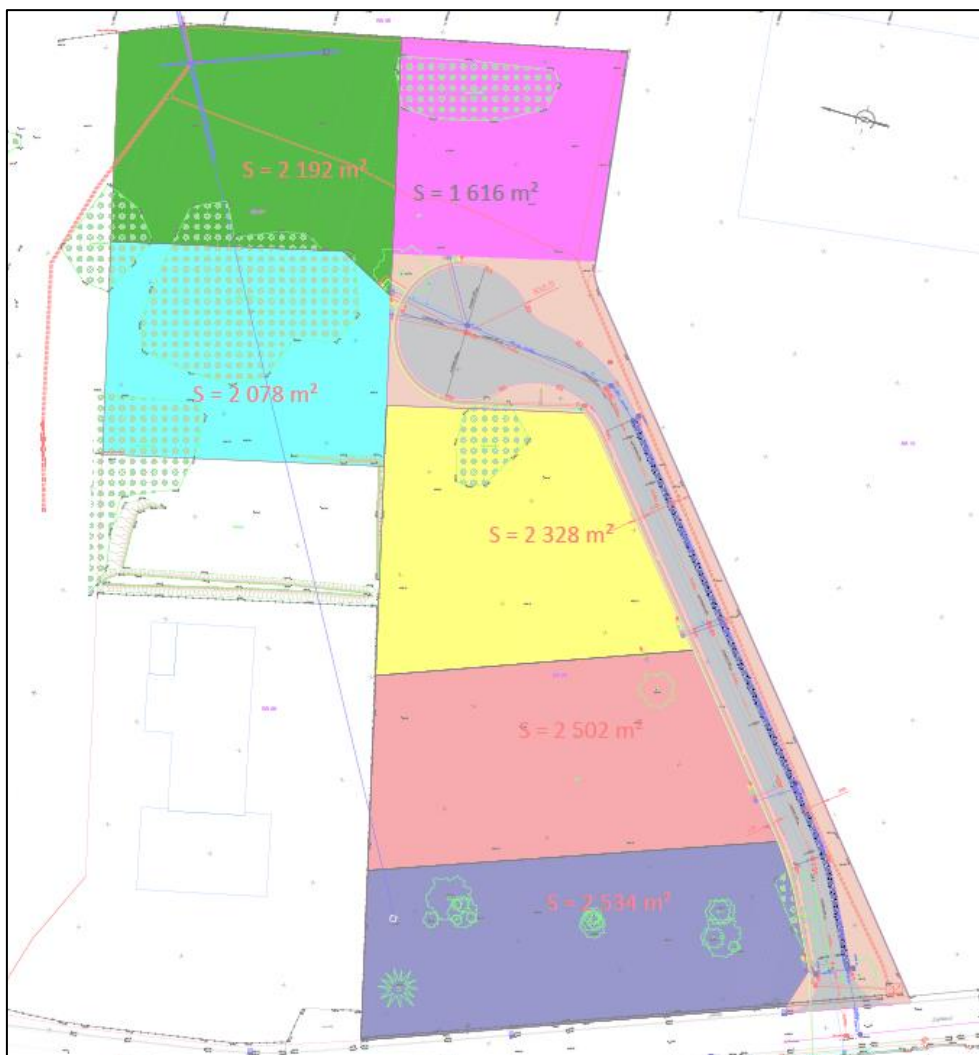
PLAN MASSE DU PROJET (SOURCE : NOVIM)
